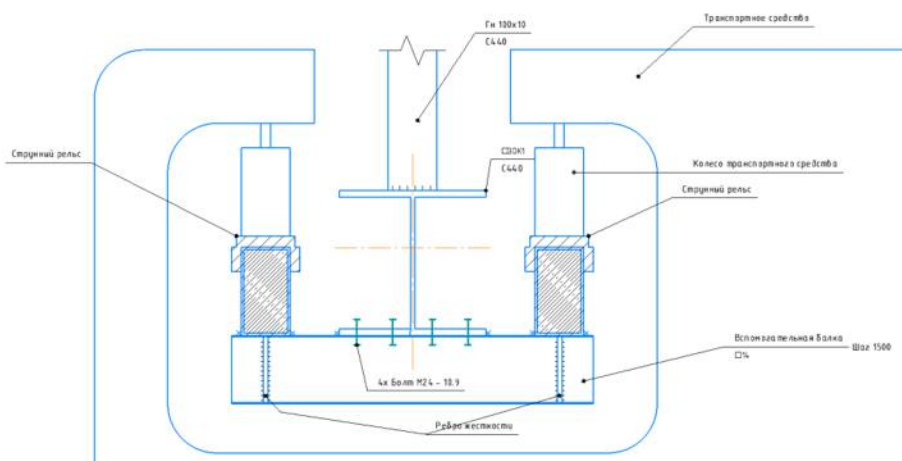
Фрагмент узла 1, крепления рельса к нижнему поясу фермы
